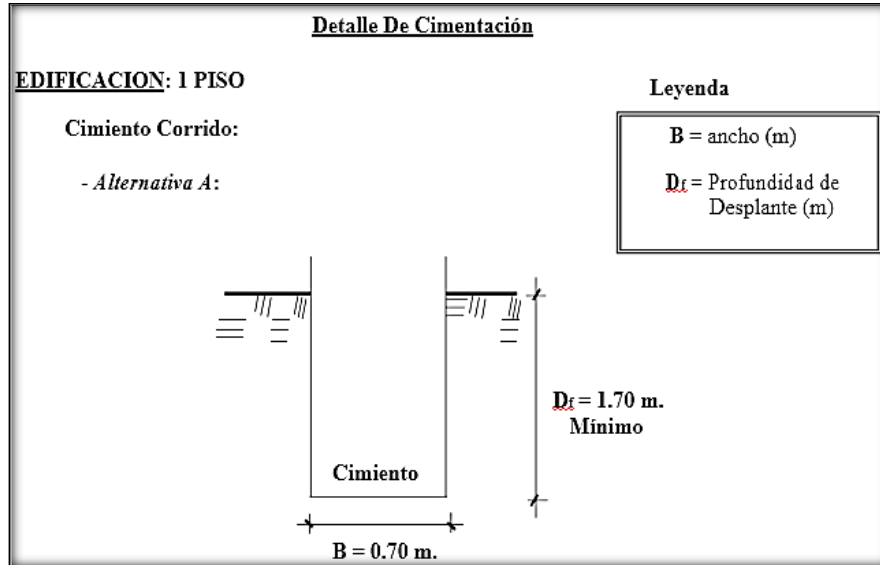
Detalle De Cimentación (Estudio de Suelos)
